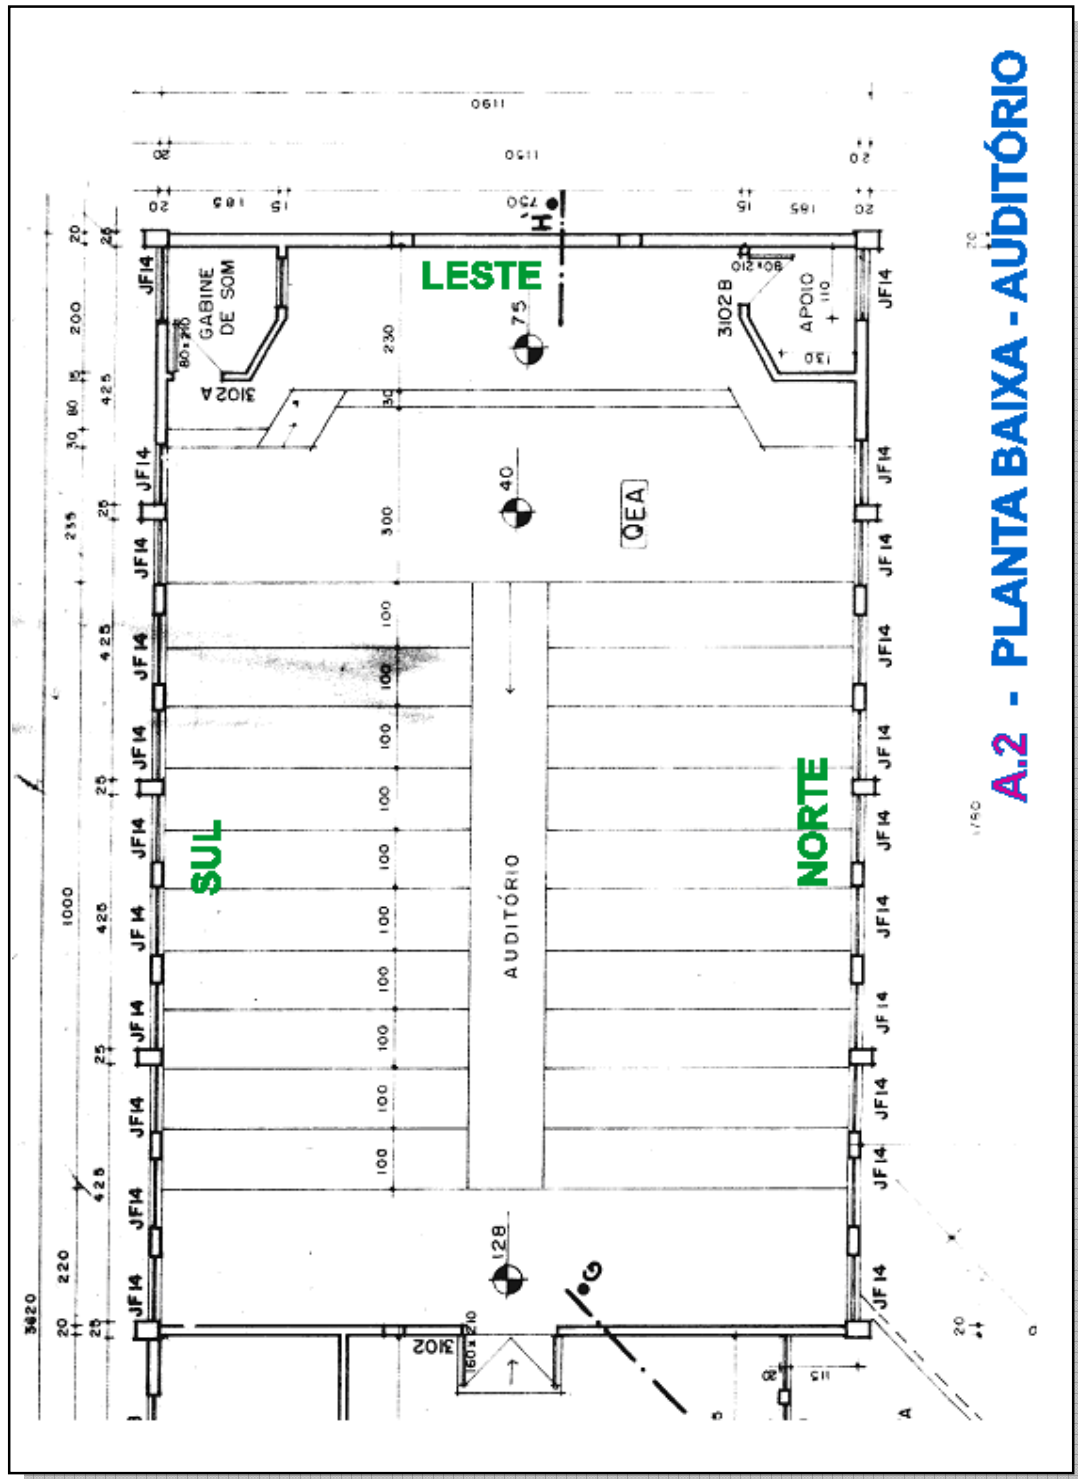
Planta baixa setor Auditório (ISAIA, 2001, p. 33)
